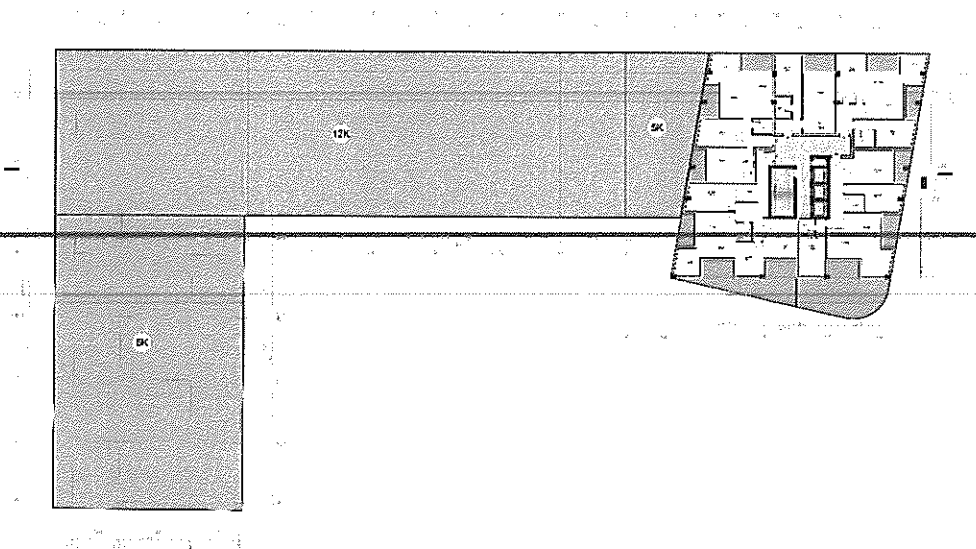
Planimetria në Kuotën +43.75 deri +75.25
